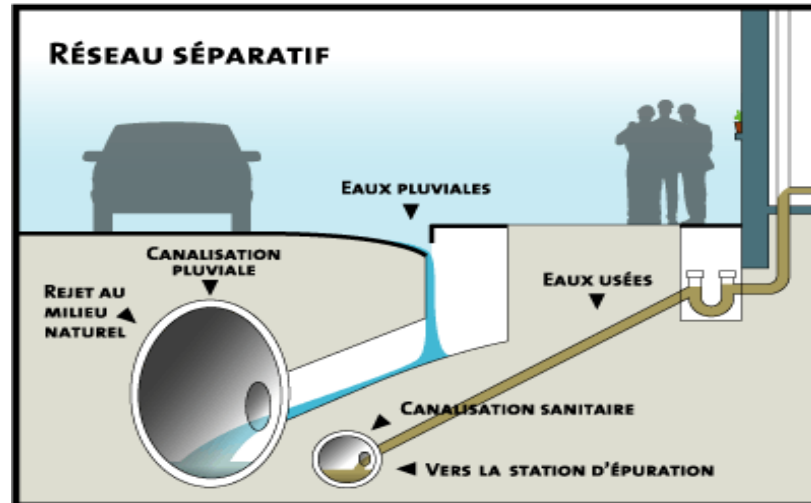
Schéma explicatif des différents branchements du réseau séparatif
